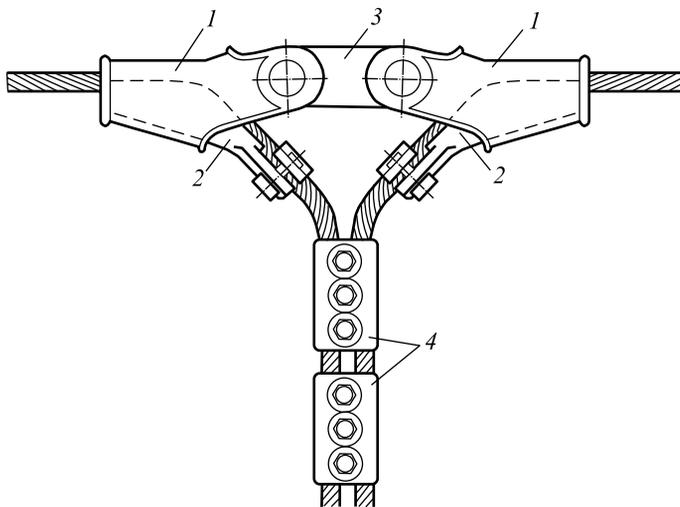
Стыкование провода ПБСА-50/70:
